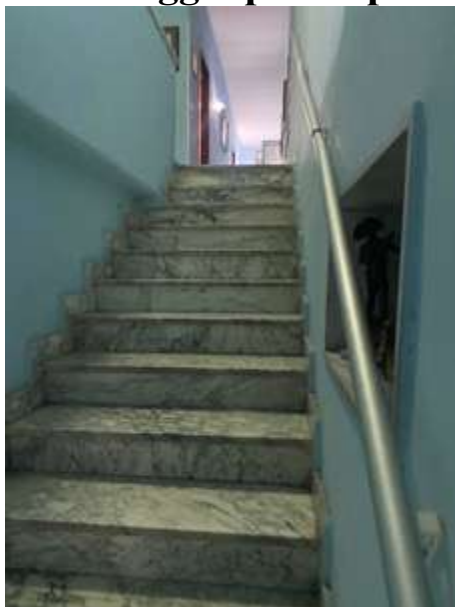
a 167: Vista alloggio primo piano sub 4
